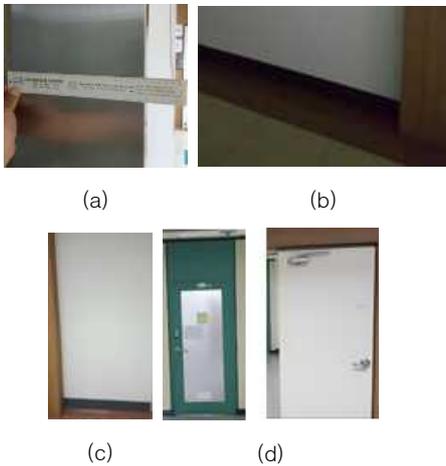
실험 공간의 벽체 (a)철근콘크리트, (b)경량칸막이(석고보드), (c) 조적조, (d)출입문(유리문, 방화문)
